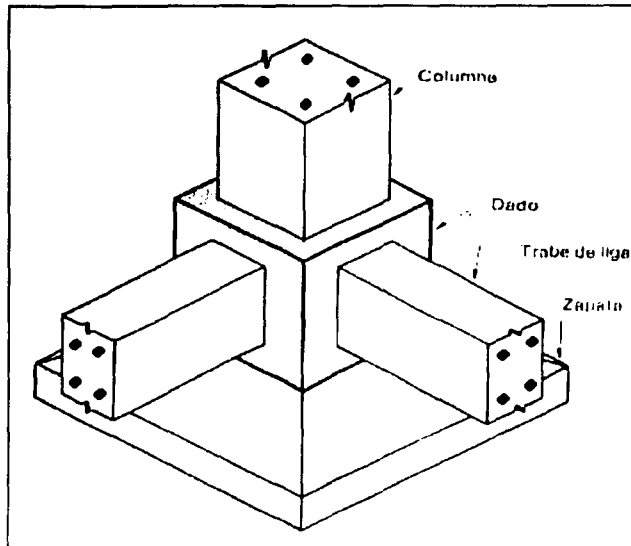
Dado en cimentación de concreto (referencia 3)
